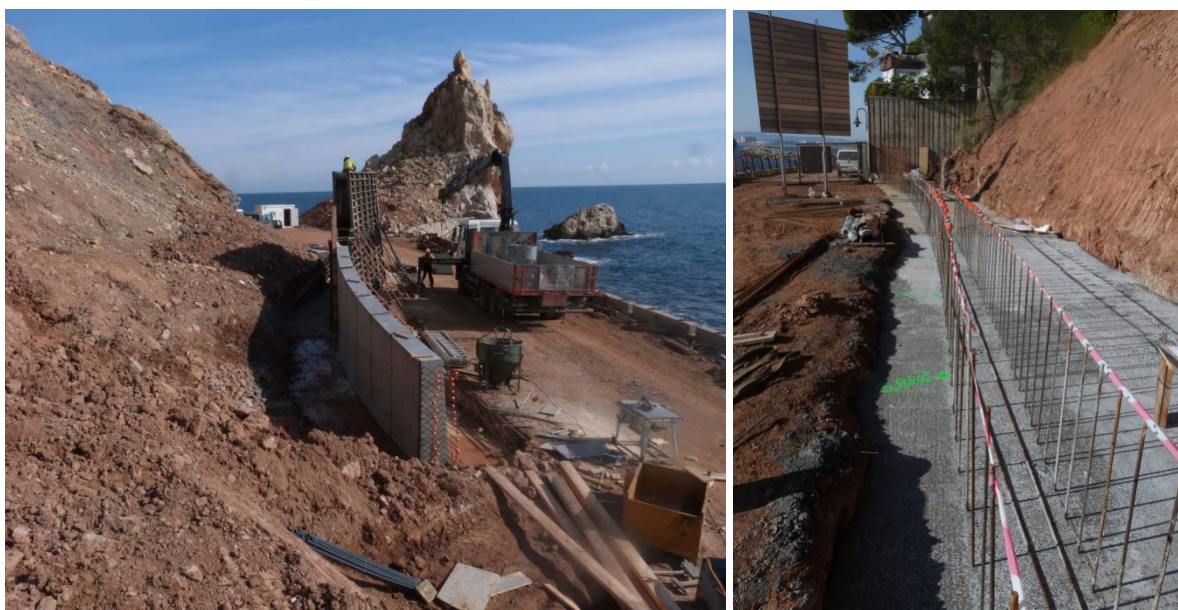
Proceso de ejecución del alzado del muro 2 y zapata del muro 1 ejecutada.
